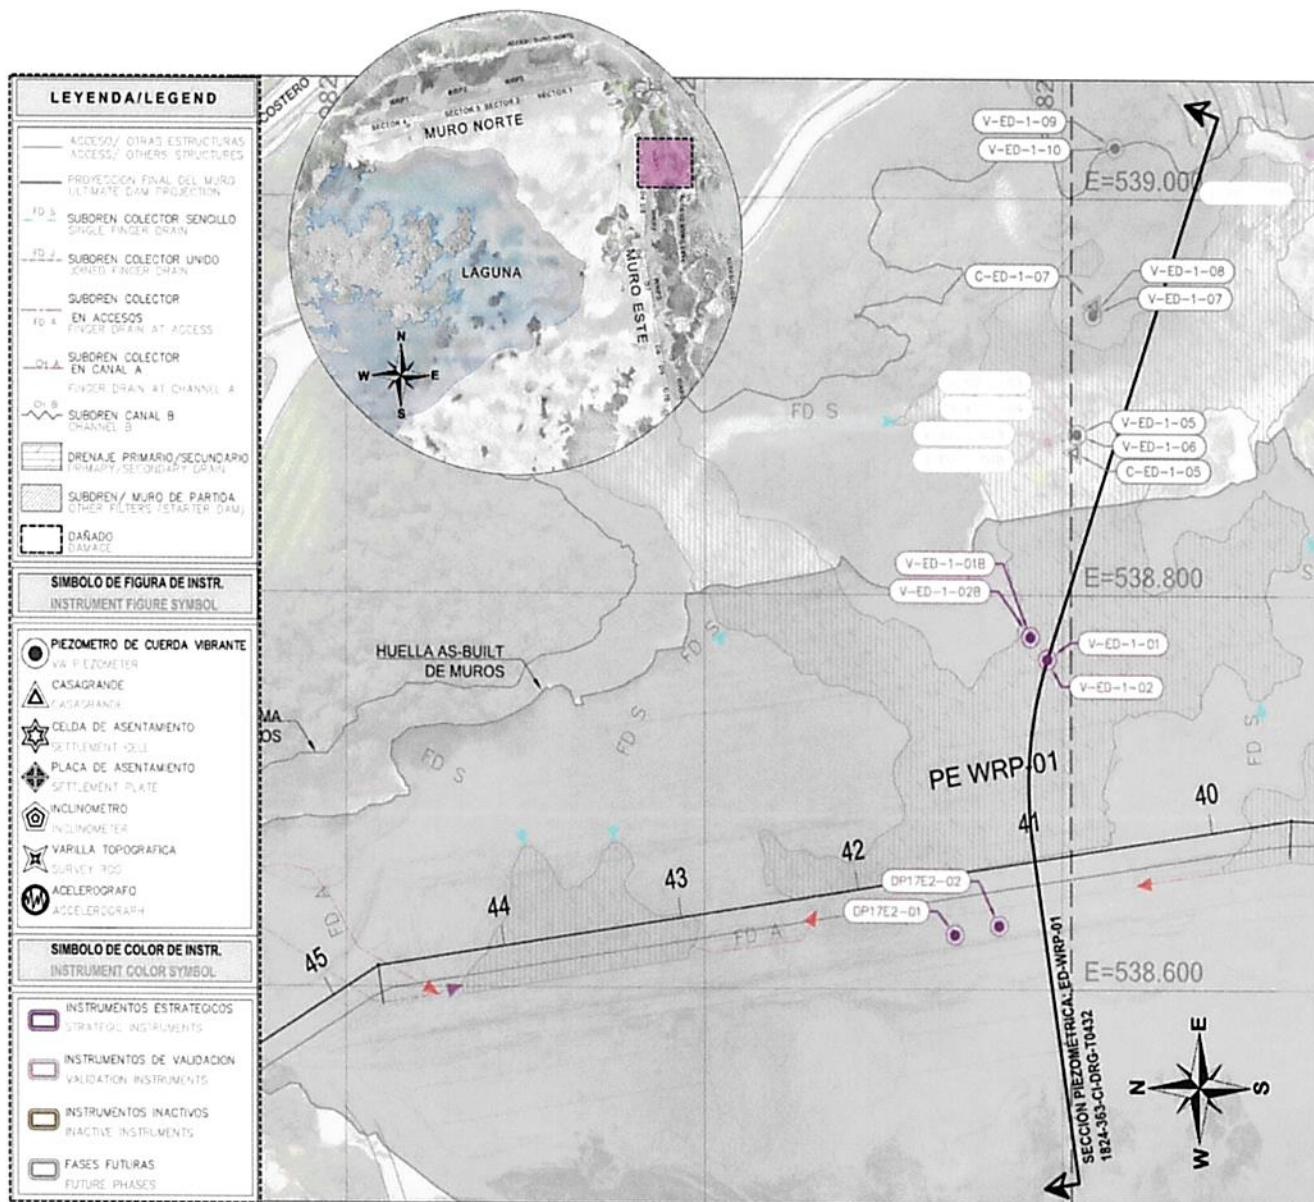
Vista de Planta en el Muro Este WRP1 con Piezómetros
